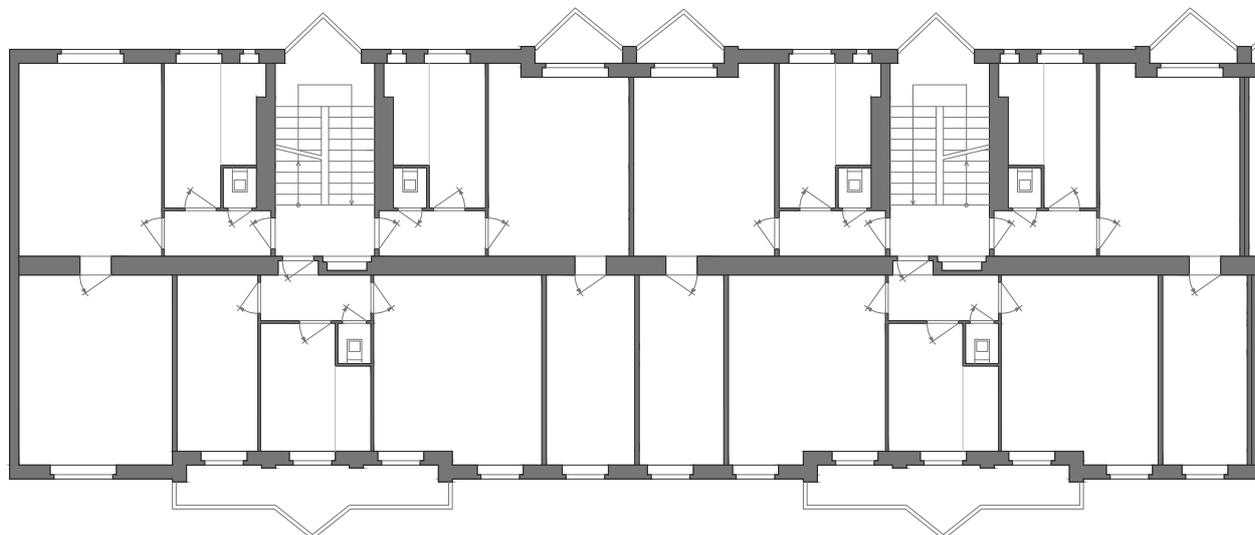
Planausschnitt vom Regelgrundriss, Bestand 1929, Mollgasse.
